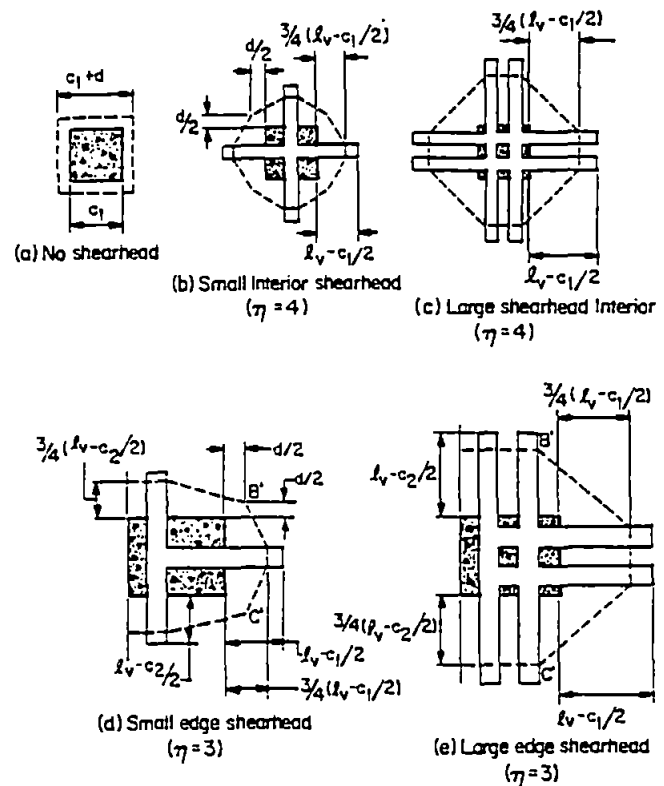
Localización de la sección crítica definida en la sección 11.12.4.7.
